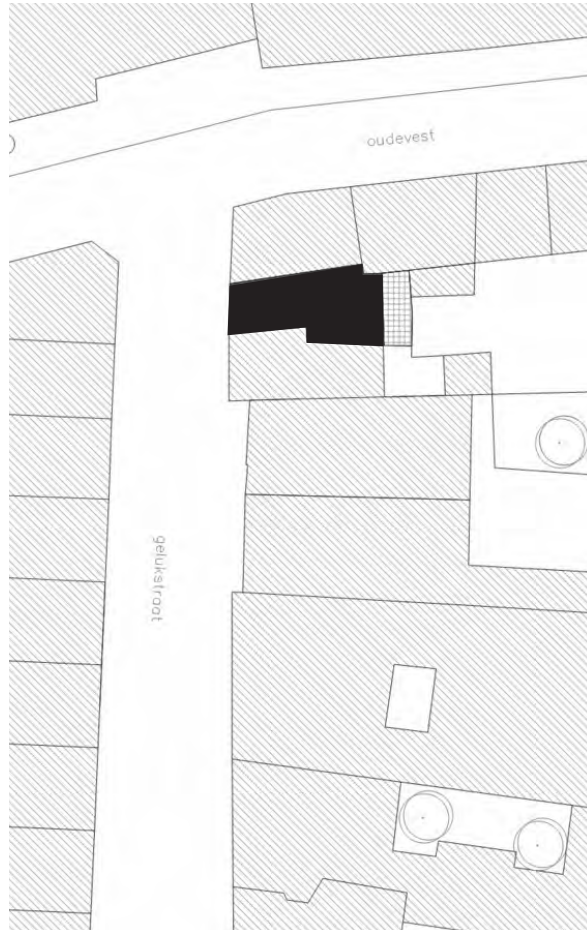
Lageplan, Quelle: Dierendonckblancke Architecten
